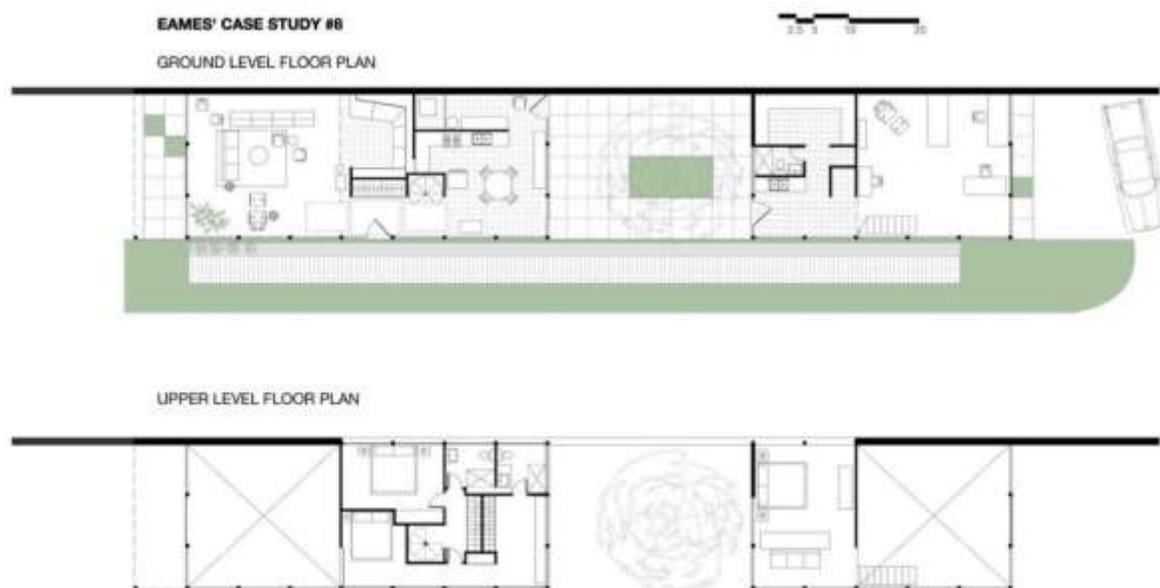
Plantas arquitectónicas de la Casa Eames. (Archiclassic)
